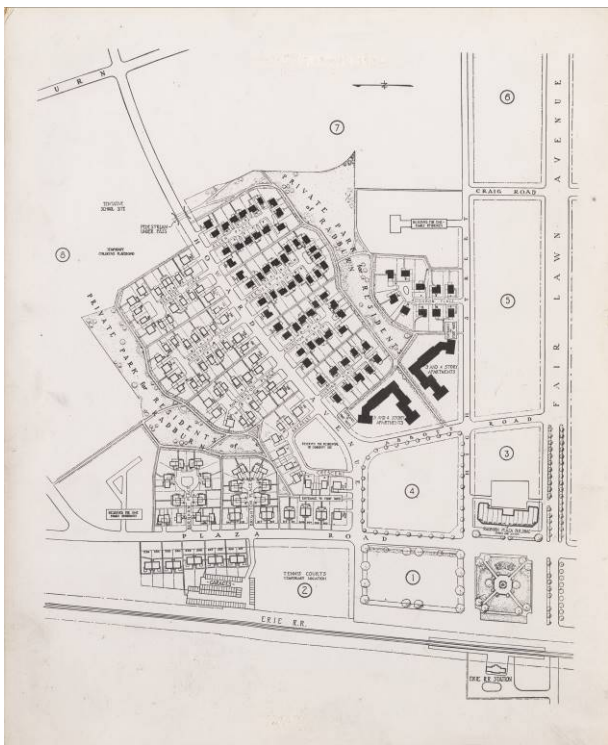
ラドバーン計画 (Radburn plan.)⁵⁰⁾
